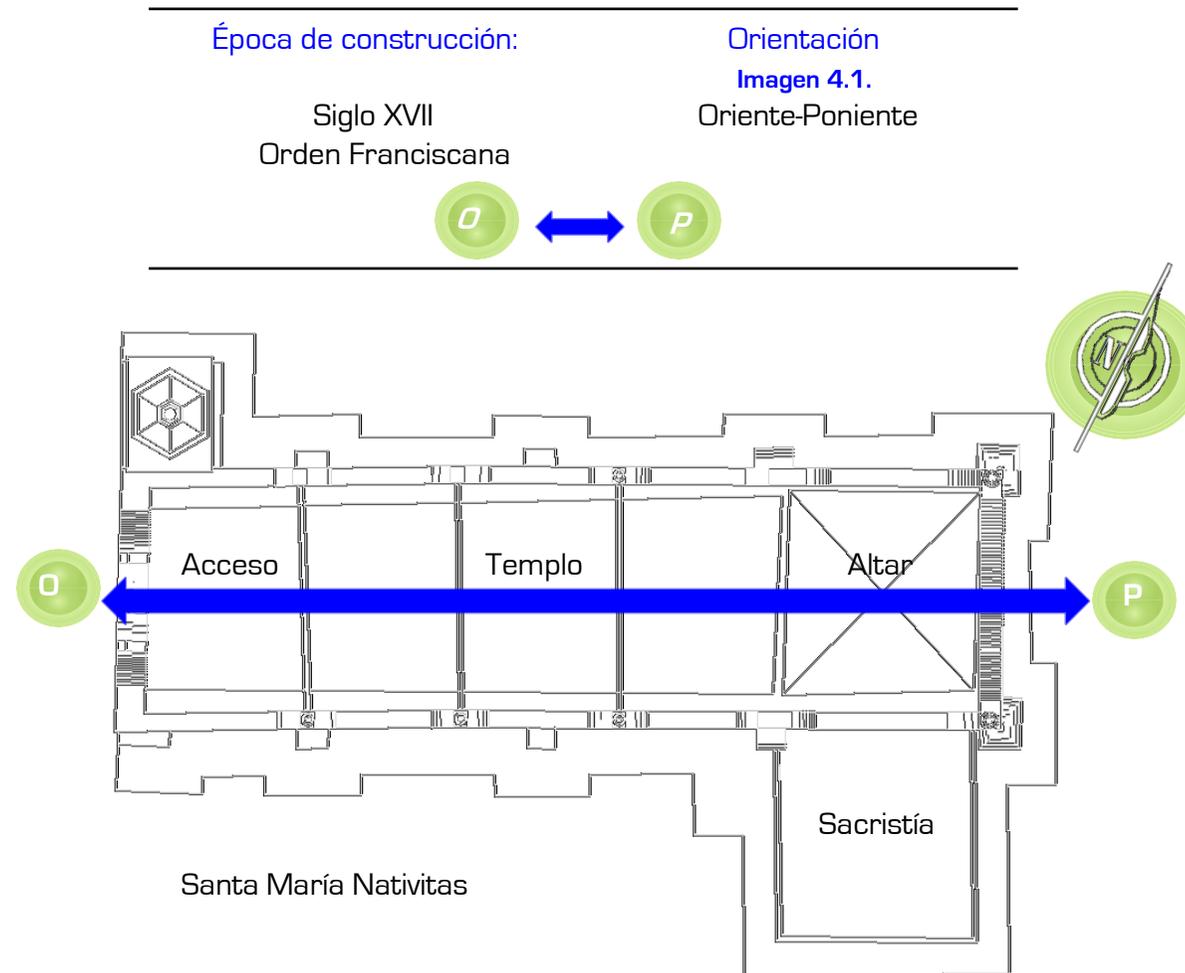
Planta arquitectónica de la capilla de Santa María Nativitas. [Orientación]
